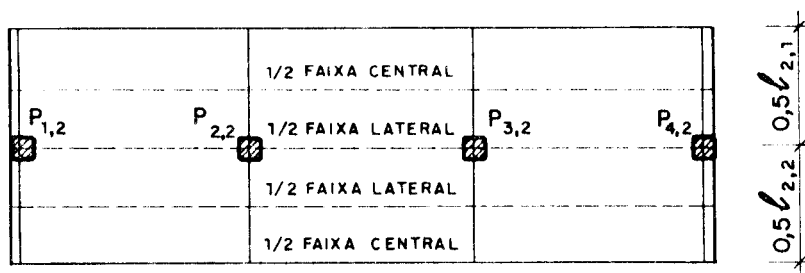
VISTA EM PLANTA DE UM PÓRTICO TÍPICO, SEGUNDO A DIREÇÃO x, (PÓRTICO PX-2) DE ACORDO COM O MODELO ALTERNATIVO.
